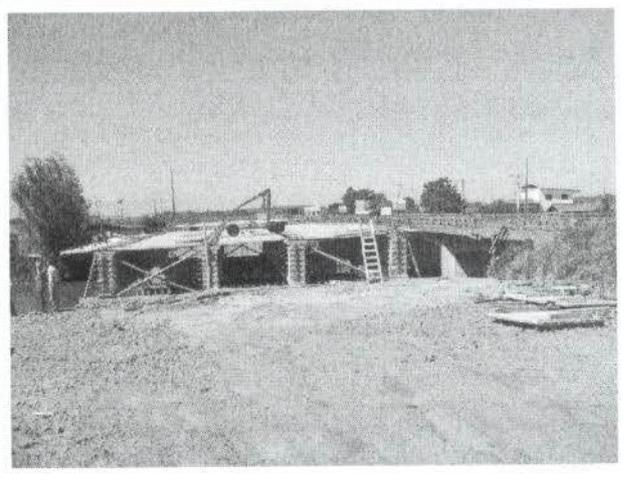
Rio Mampituba. Está em análise projeto para implantação de rampa de acesso na margem direita do rio.
